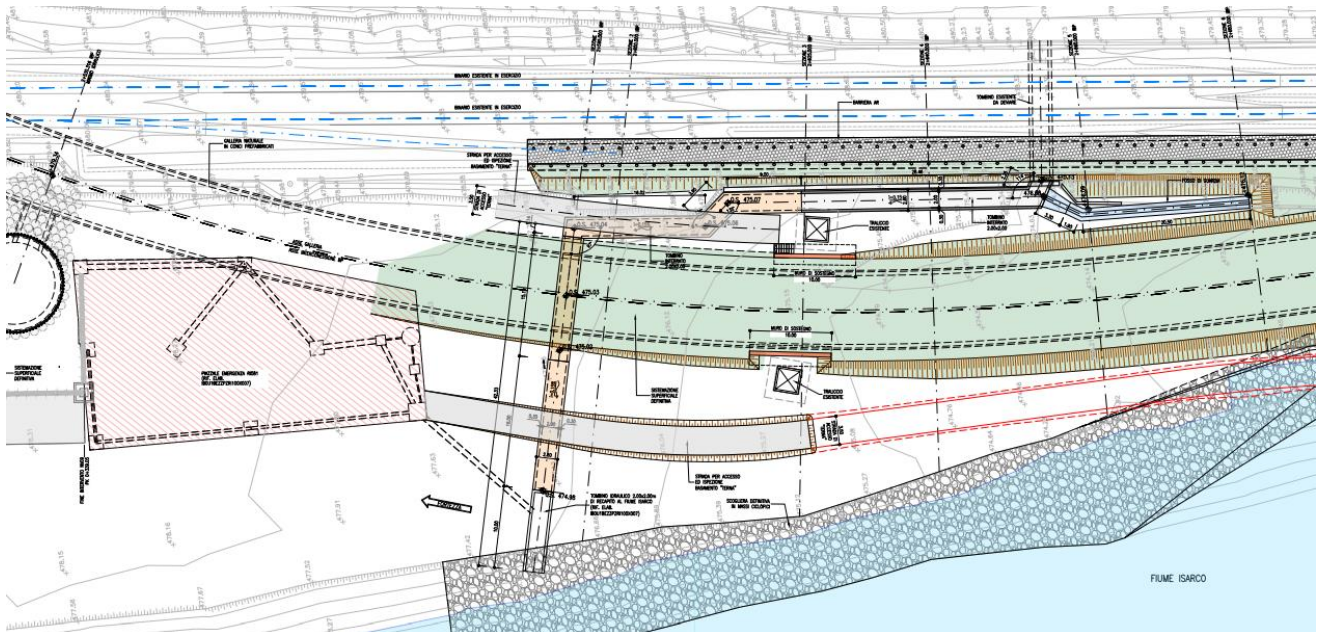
Stalcio planimetrico intervento in progetto (vedi IB0U1BEZZBZSI0700001)
